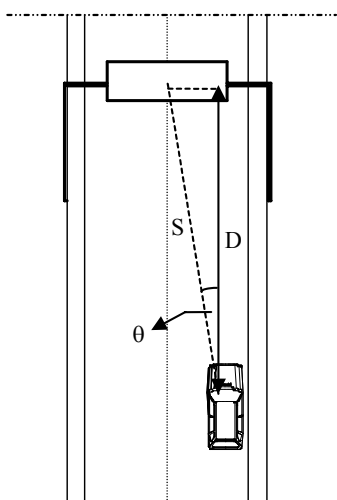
Distanza di leggibilità della segnaletica stradale.
